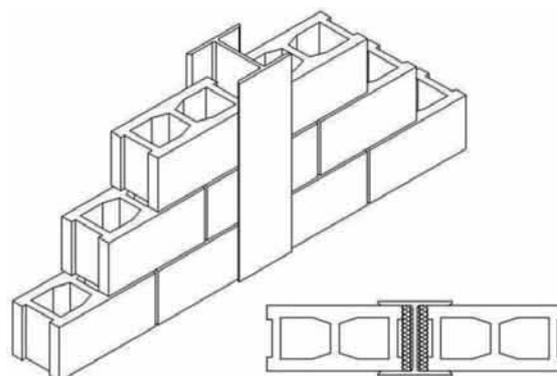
Muro embocado entre las alas de un soporte metálico HEB.
